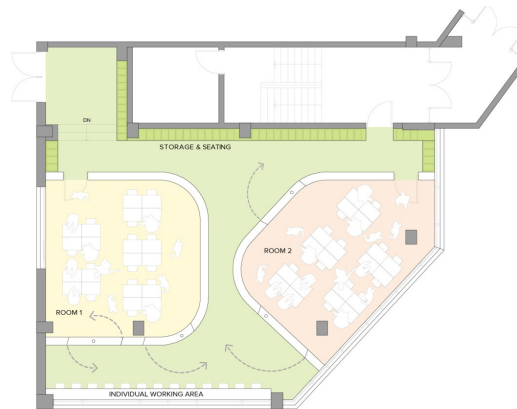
DSSI Elementary School Renovation. Layout di progetto
